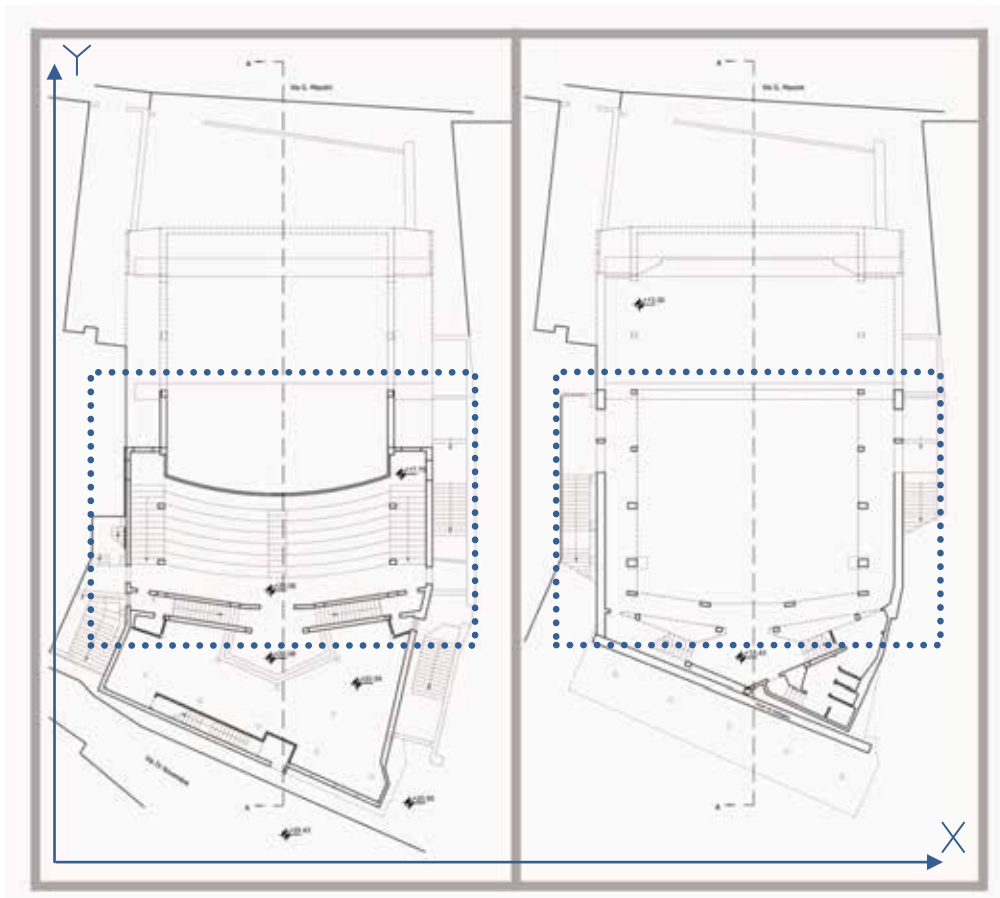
Pianta Atrio-Galleria q:+20.58/+17.70; Pianta Platea q:+15.43/+13.30
